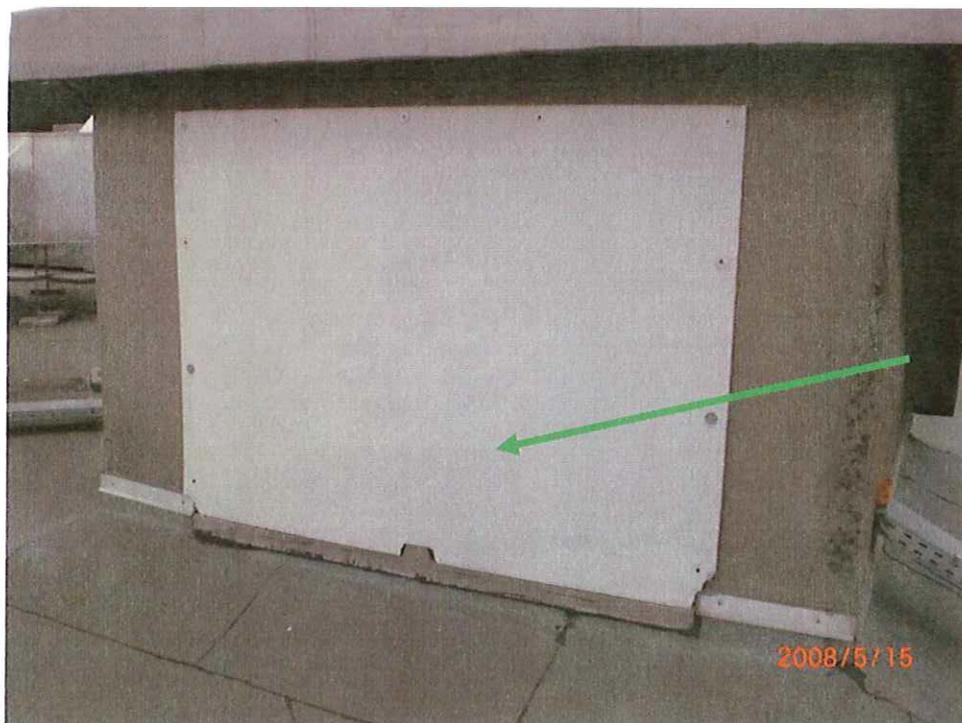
Bâtiment B – Toiture – Local aération – Plaque de fermeture – NEGATIF
